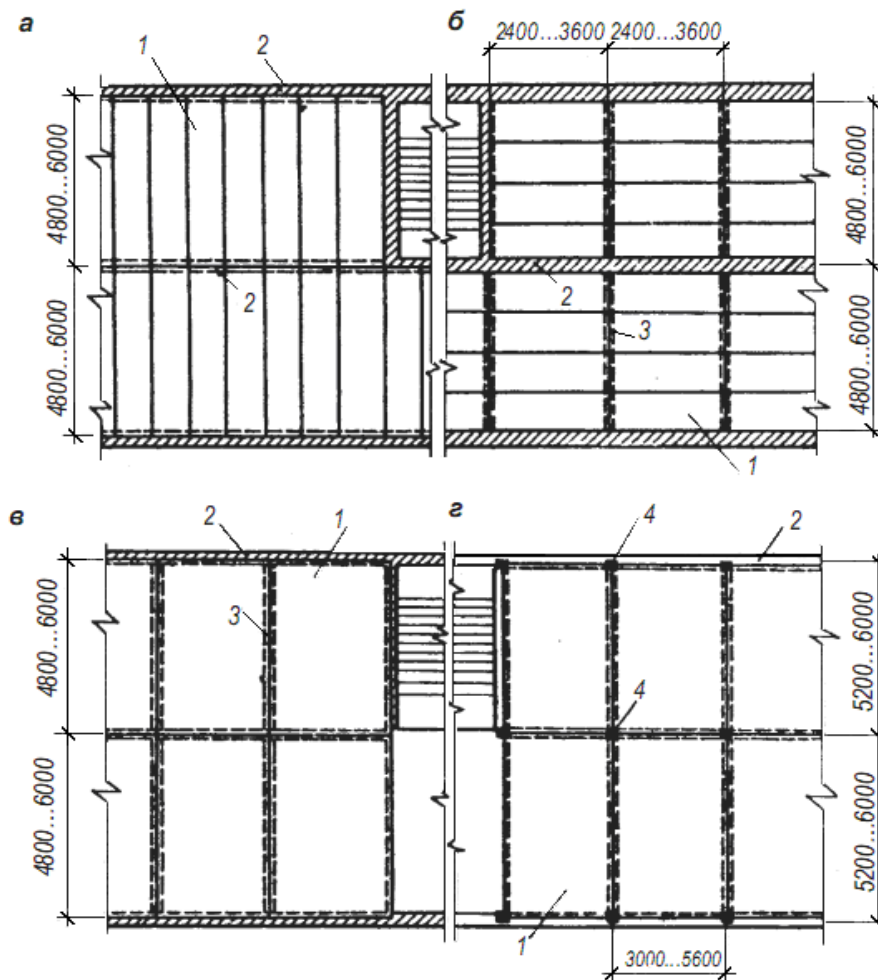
Схеми перекриття із панелей: а – із залізобетонних панелей з опиранням на поздовжні стіни або прогони; б – теж, на поперечні стіни або прогони; в – із панелей, що спираються по контуру; г – із панелей з опиранням на колони по чотирьох кутах; 1 – панелі перекриття; 2 – поздовжні стіни; 3 – поперечні стіни або прогони; 4 – колони
